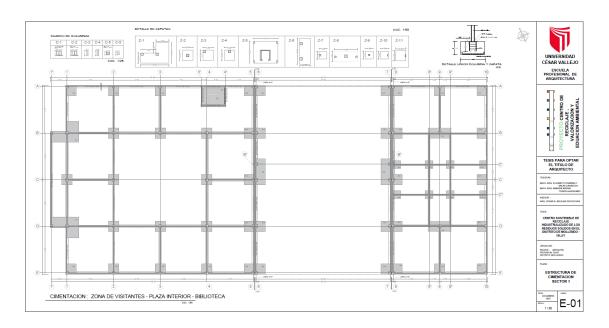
Plano de Cimentación, Sector Seleccionado FUENTE: Elaboración Propia
